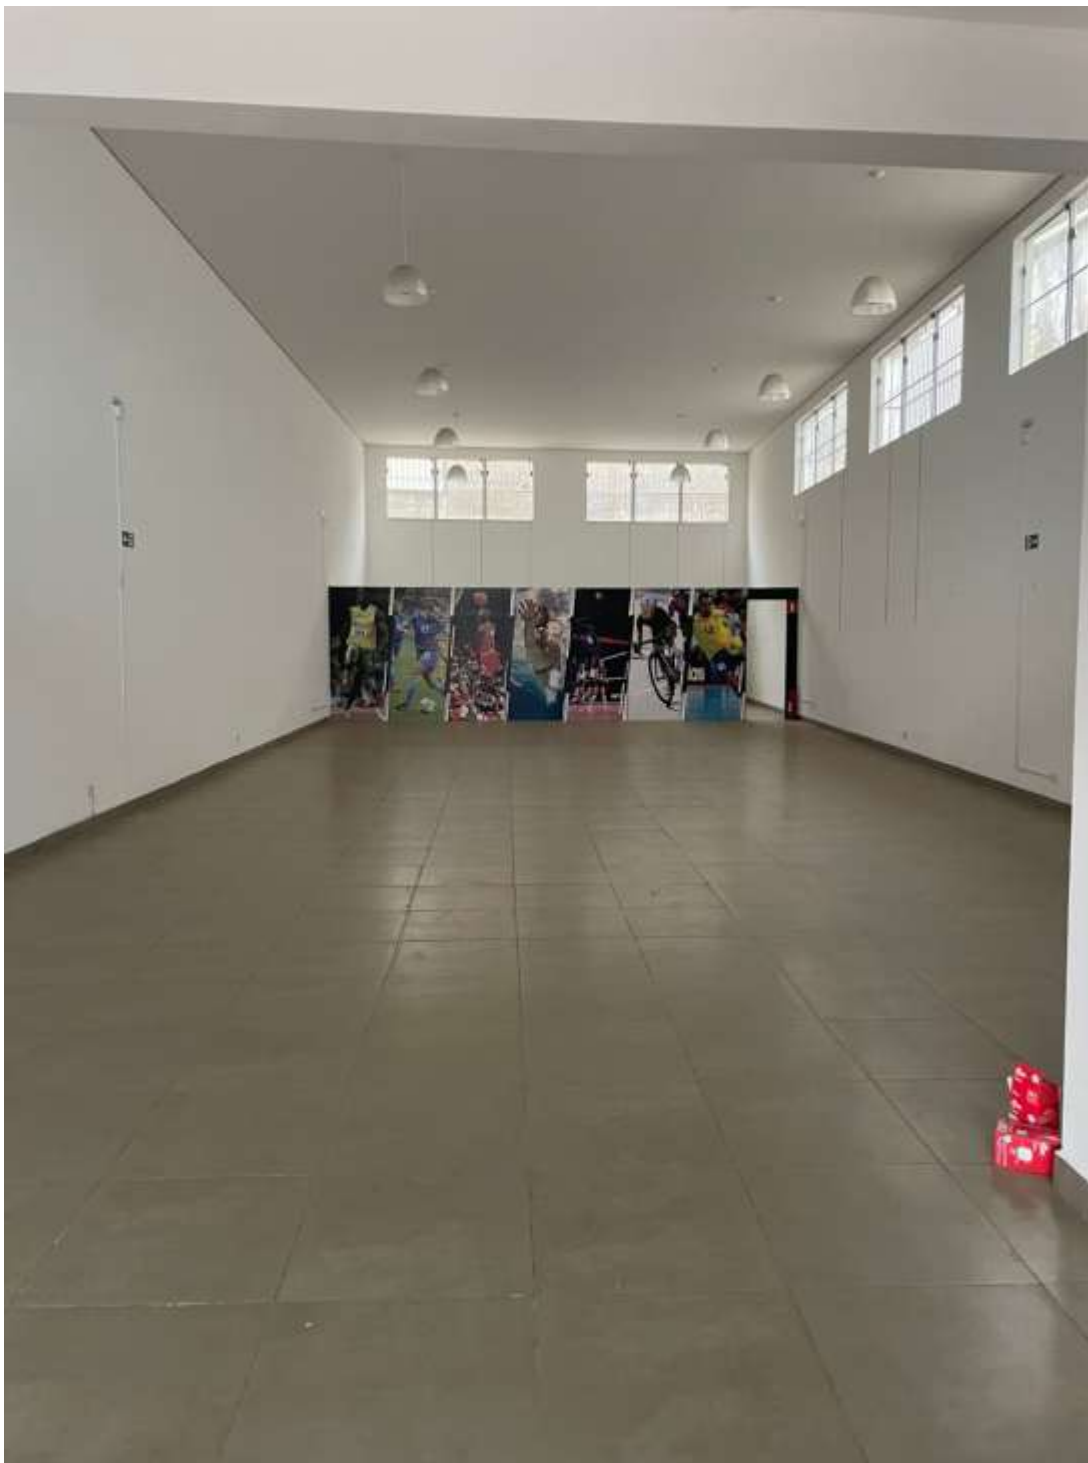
Fissuras identificadas em parede interna.
